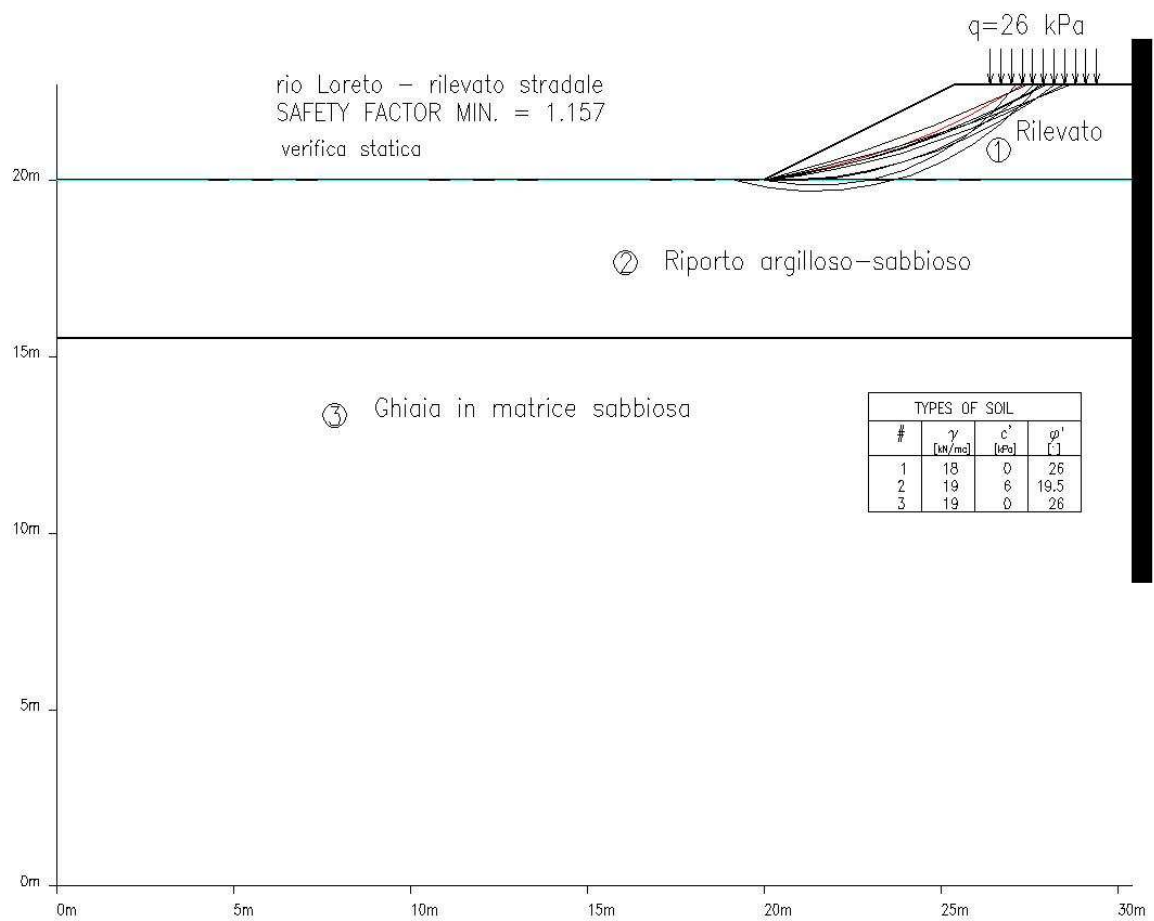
rilevato pista di servizio – analisi di stabilità – verifica statica (non in scala)
